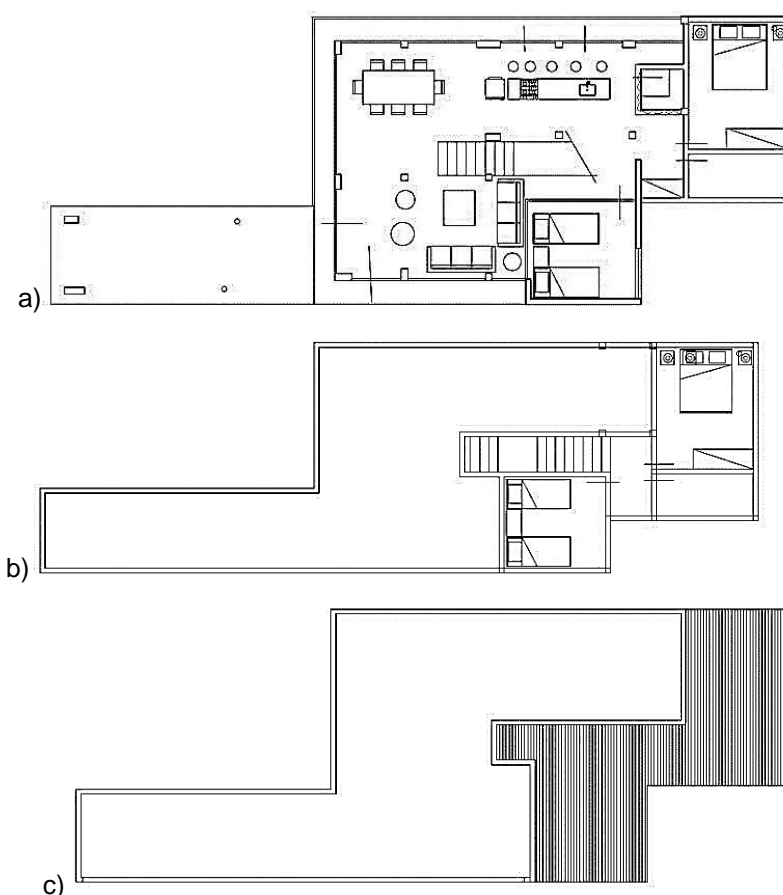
Primeiras plantas feitas em AutoCAD pelo arquiteto 1
